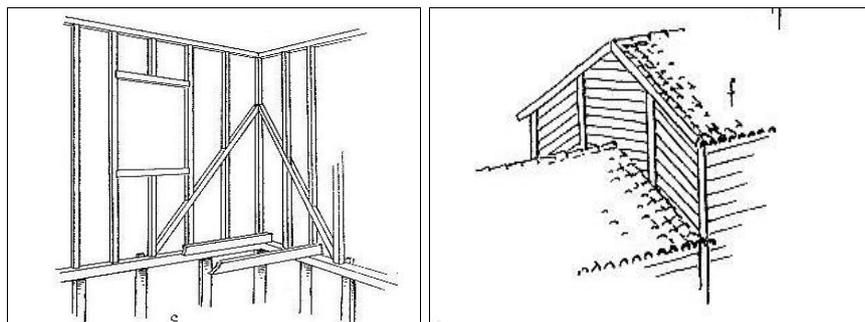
Palheiros de Mira – Pormenores de construção. Grade de vigas, onde assenta o esqueleto do edifício (c). Cobertura (f)
